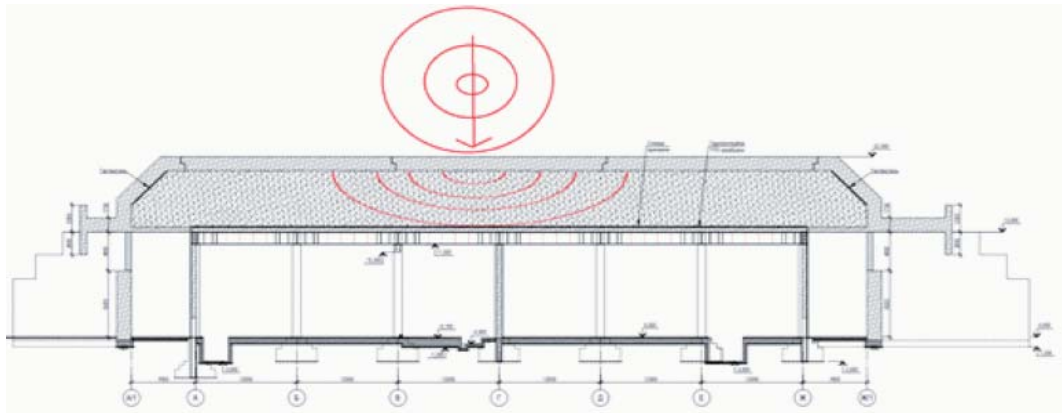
Схема впливу вибухового навантаження на захисну споруду
